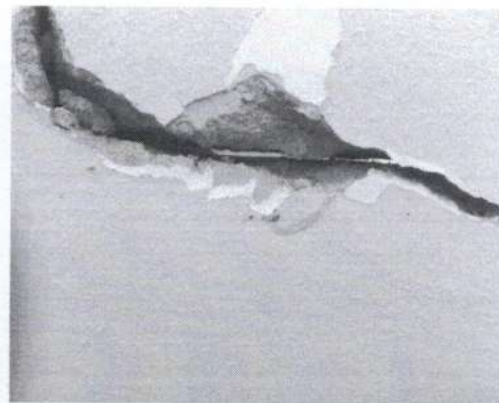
Trinca localizada em alvenaria interna da edificação
